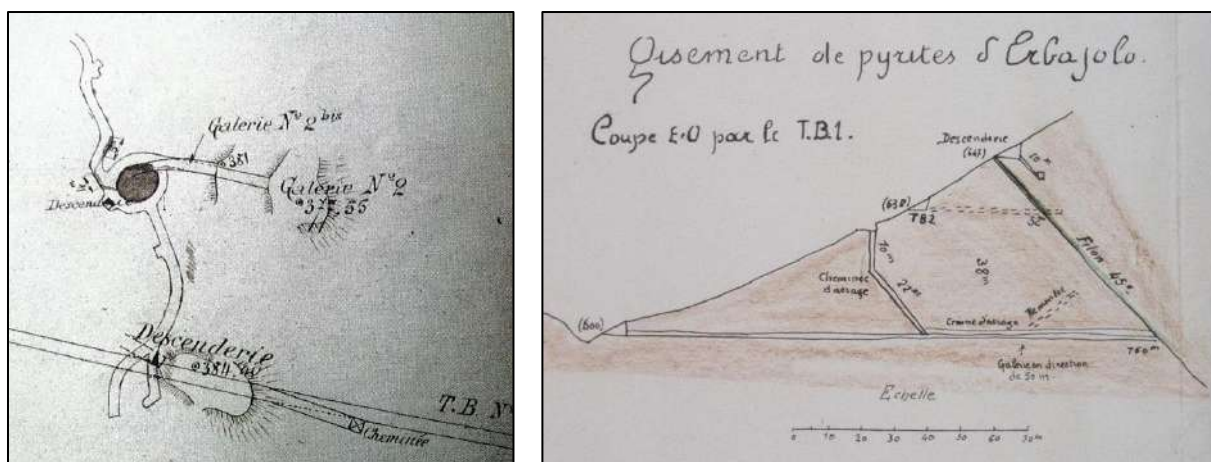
Plan et coupe des travaux de Ferralacce (Erbajolo)
